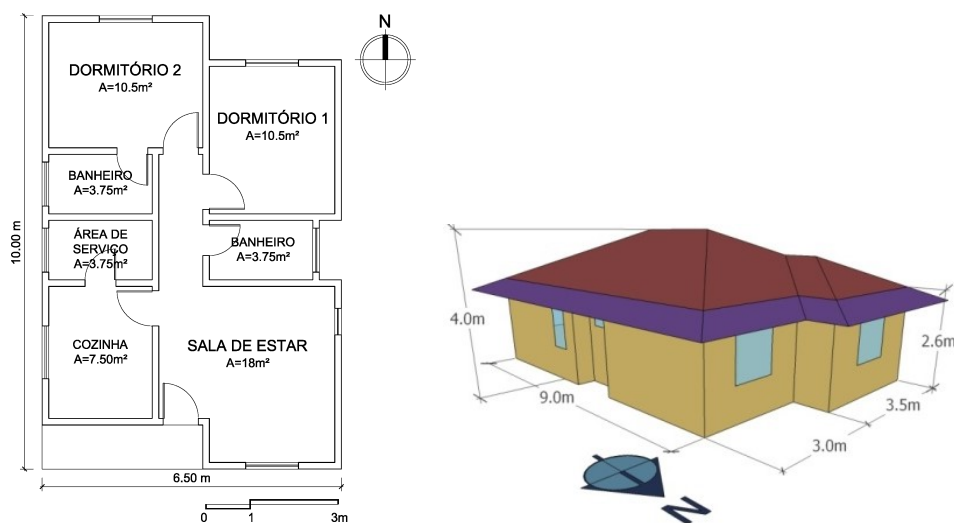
Planta baixa e Perspectiva. Fonte: Elaborado pelos autores.
